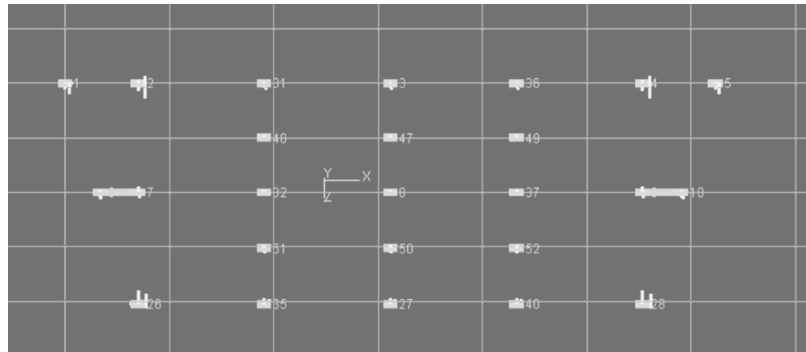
Grupo Zapatas Aisladas y Combinadas Gradería Teatro Vista Planta
